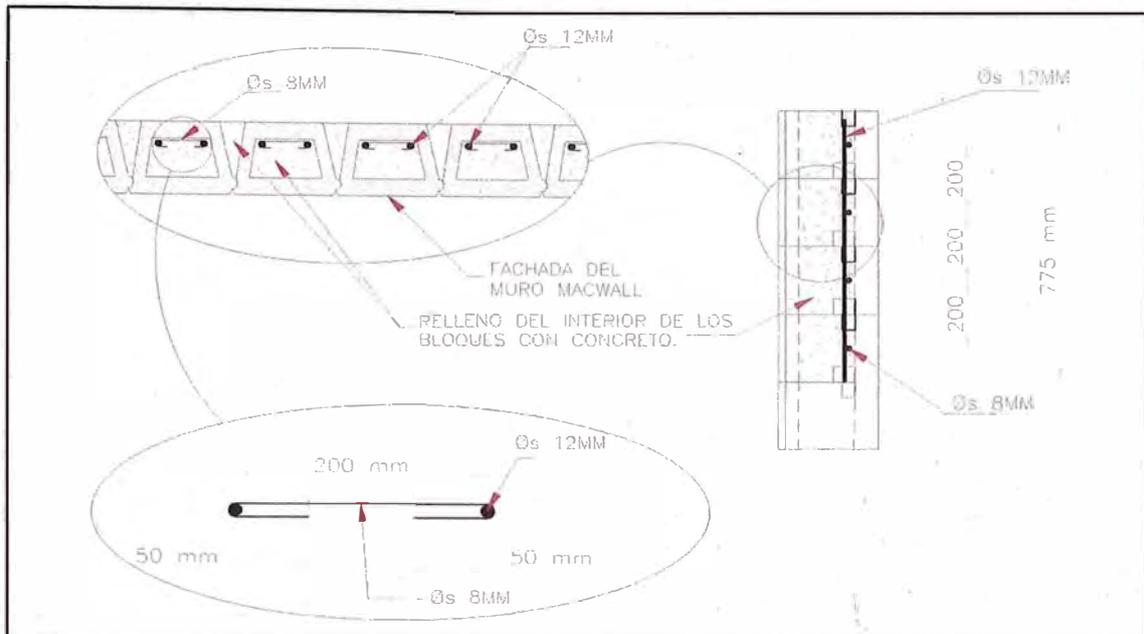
Muro de suelo reforzado – Detalle de relleno de concreto en alveolos.
